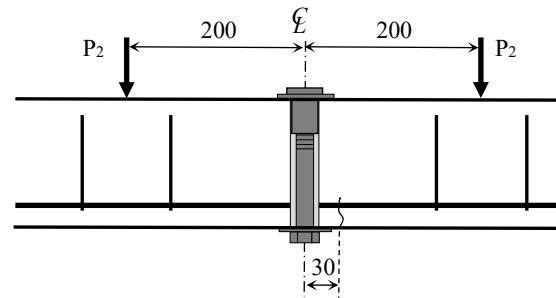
試験体 2 の圧縮力導入位置・ひび割れの位置
